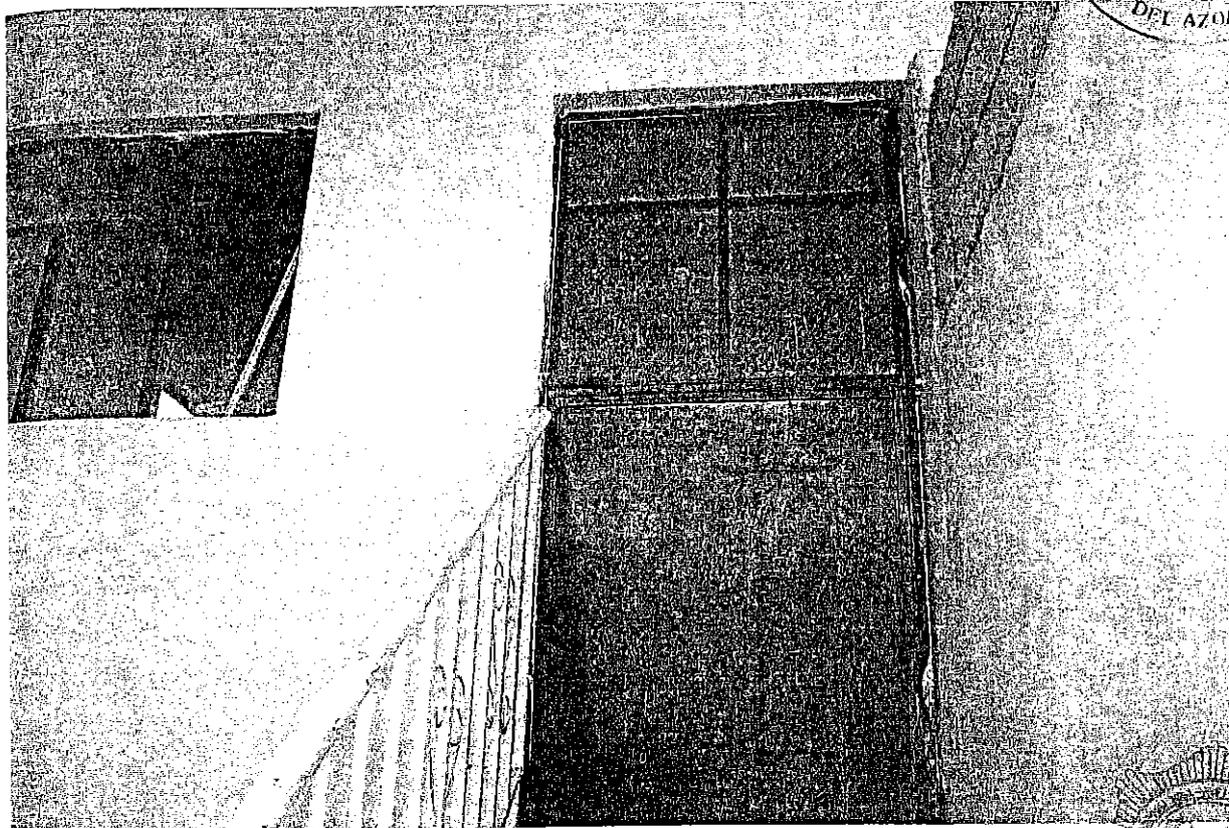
Fotografía de semi-conjunto, en la que se aprecia la puerta que permite el acceso al interior de la segunda planta de la edificación.
